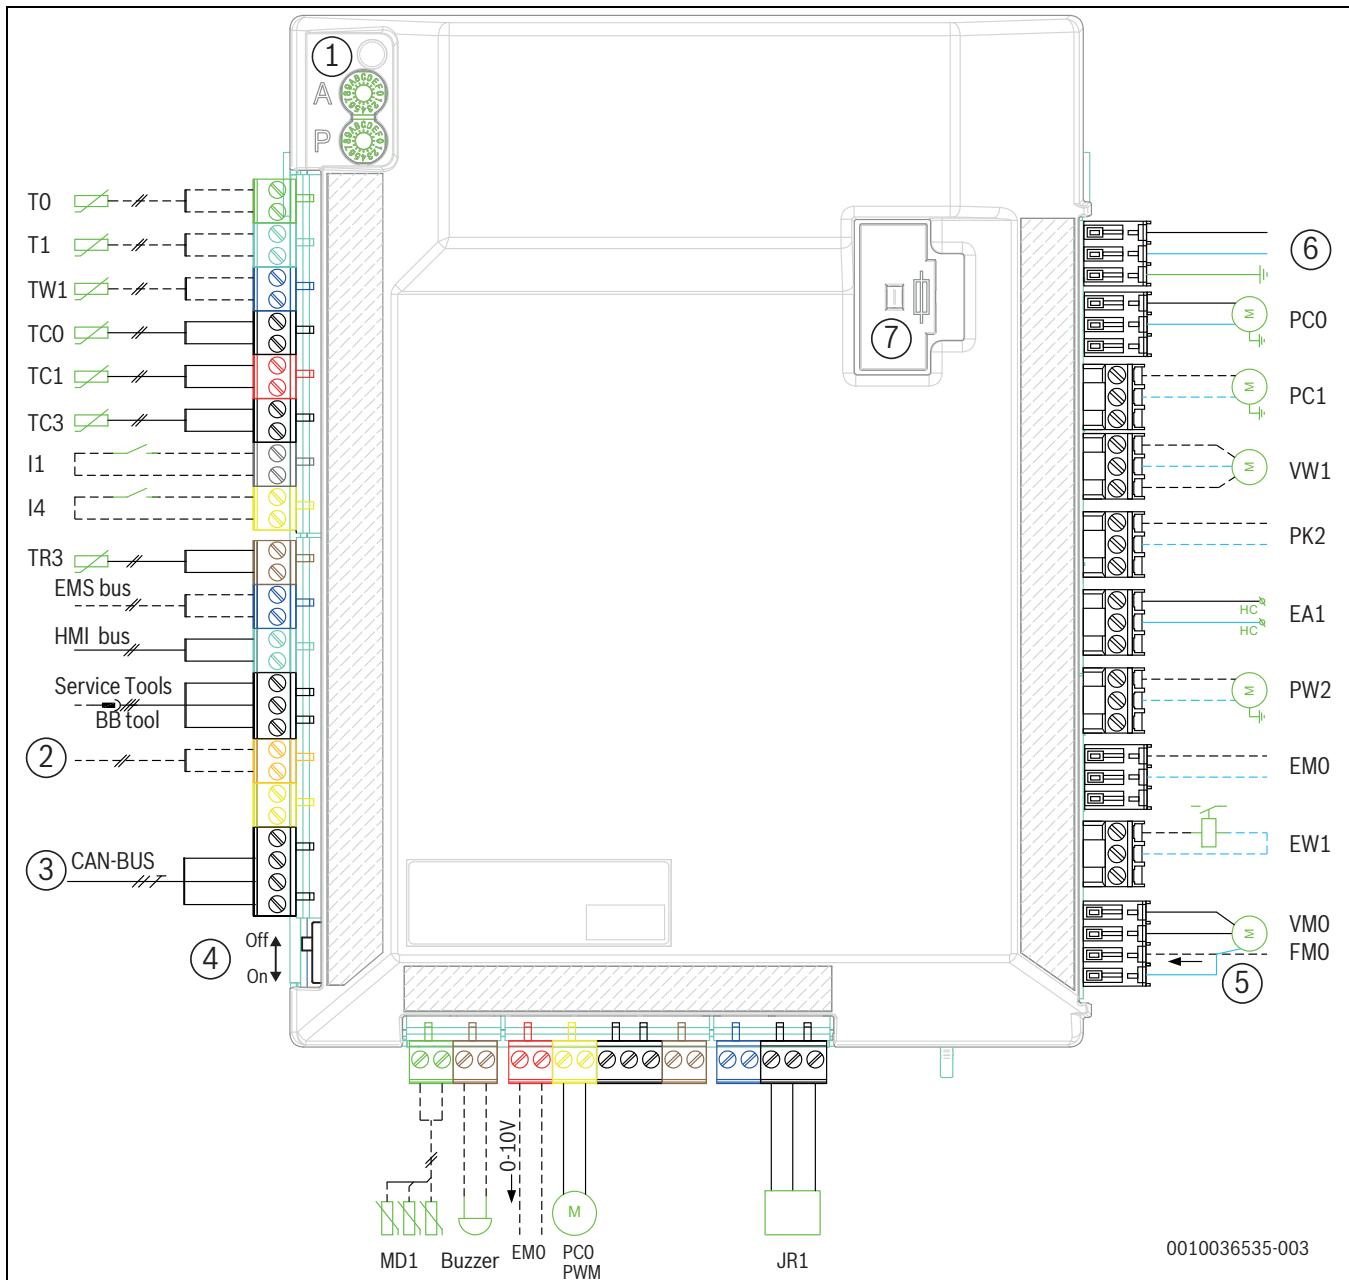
Schema elettrico di collegamento del modulo di installazione
